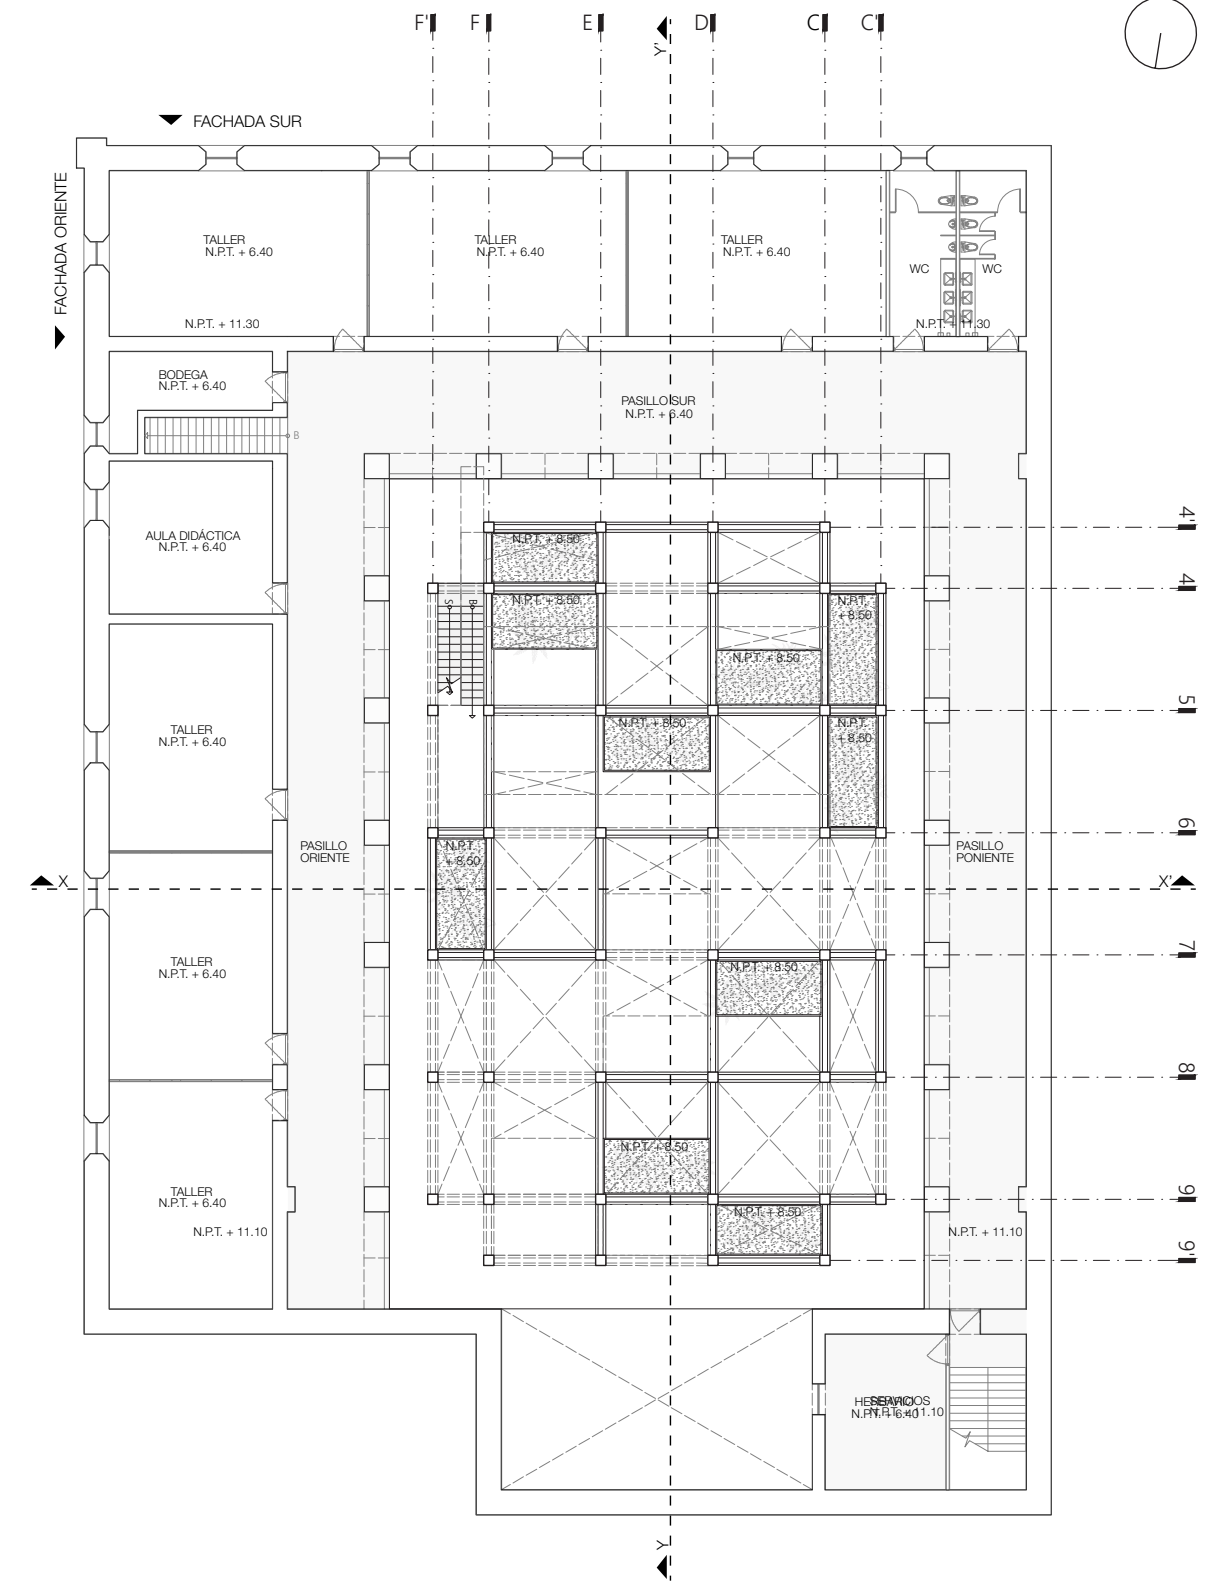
Planta arquitectónica nivel +8.50m. Fuente: Elaboración propia.
